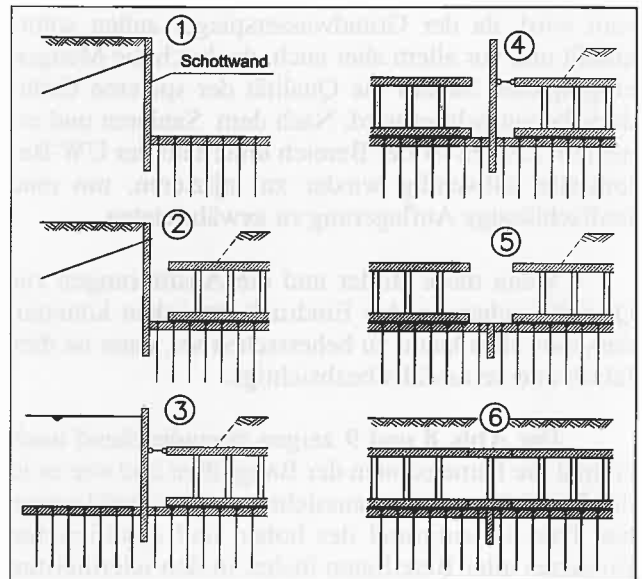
Bauablauf zur Kopplung zweier Baugruben
